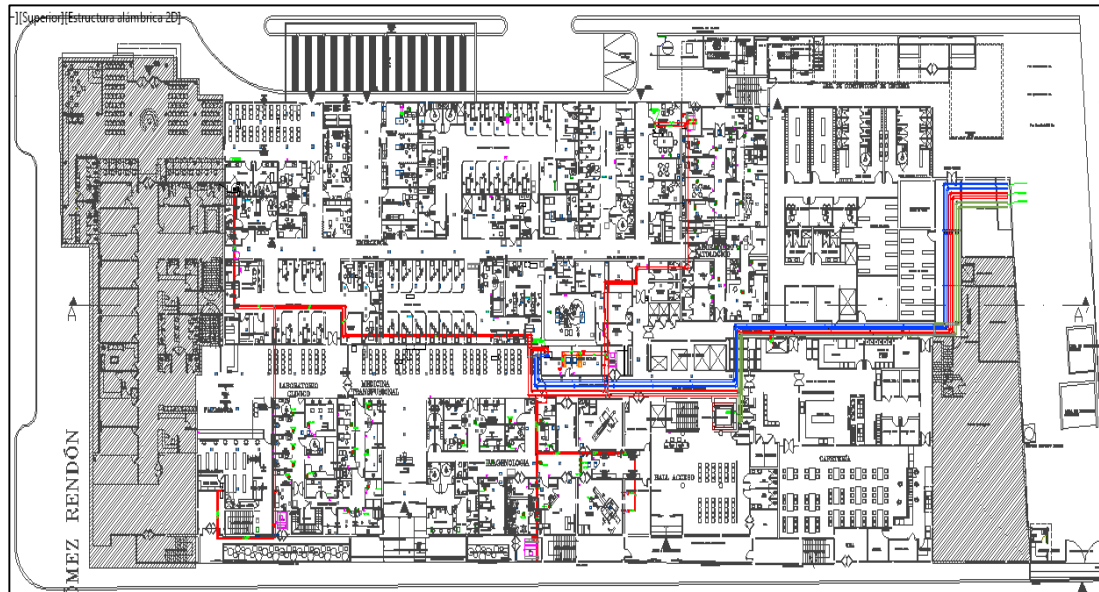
Esquema del Recorrido de Tubería para Planta Baja
